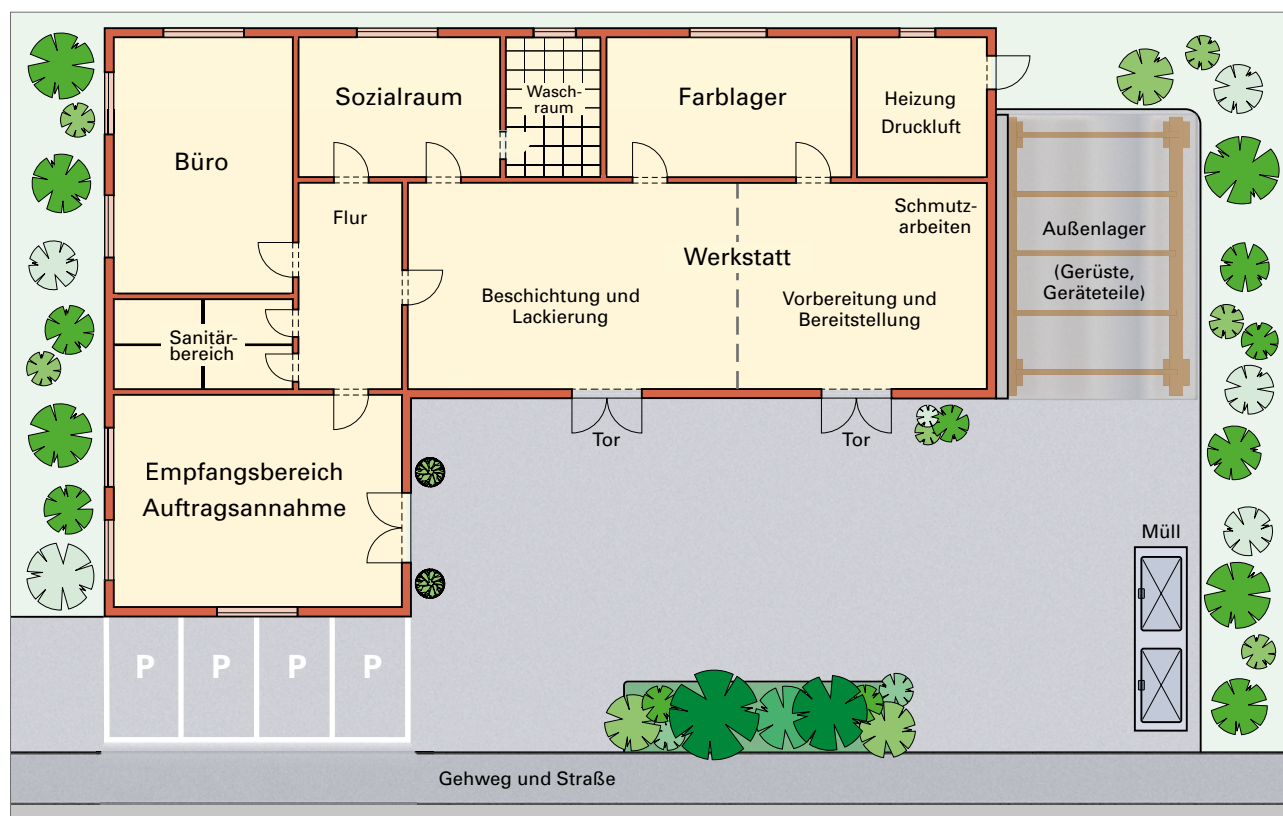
Möglicher Grundriss eines Malerbetriebes
